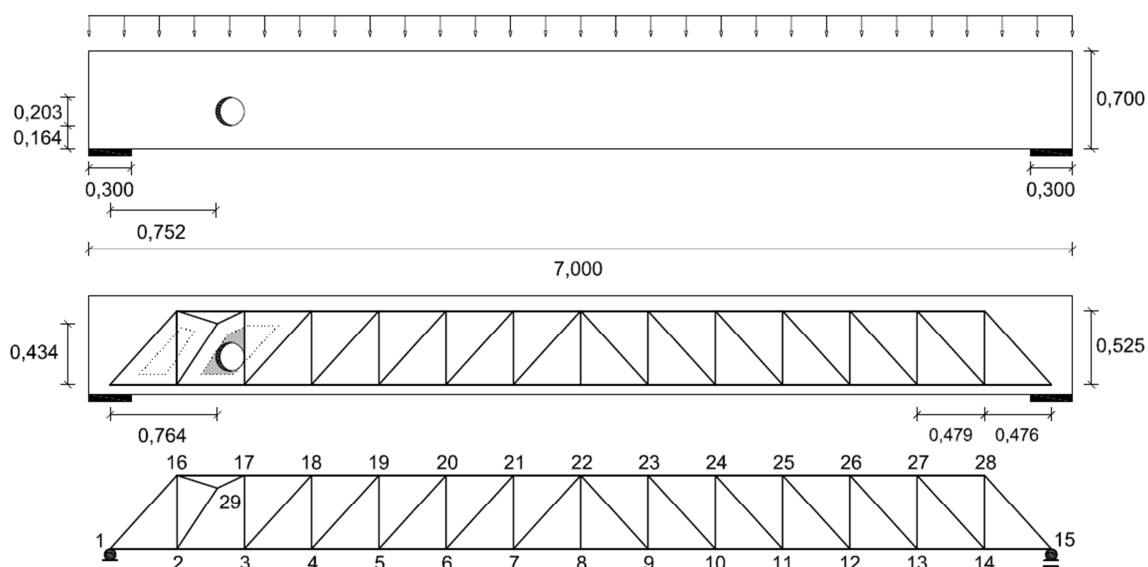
Elemento estrutural e treliça representativa (Viga 6) – Secção 0,70x0,30.
